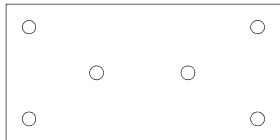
Plans de chevillage – panneaux de dimensions 1000 × 500 mm
